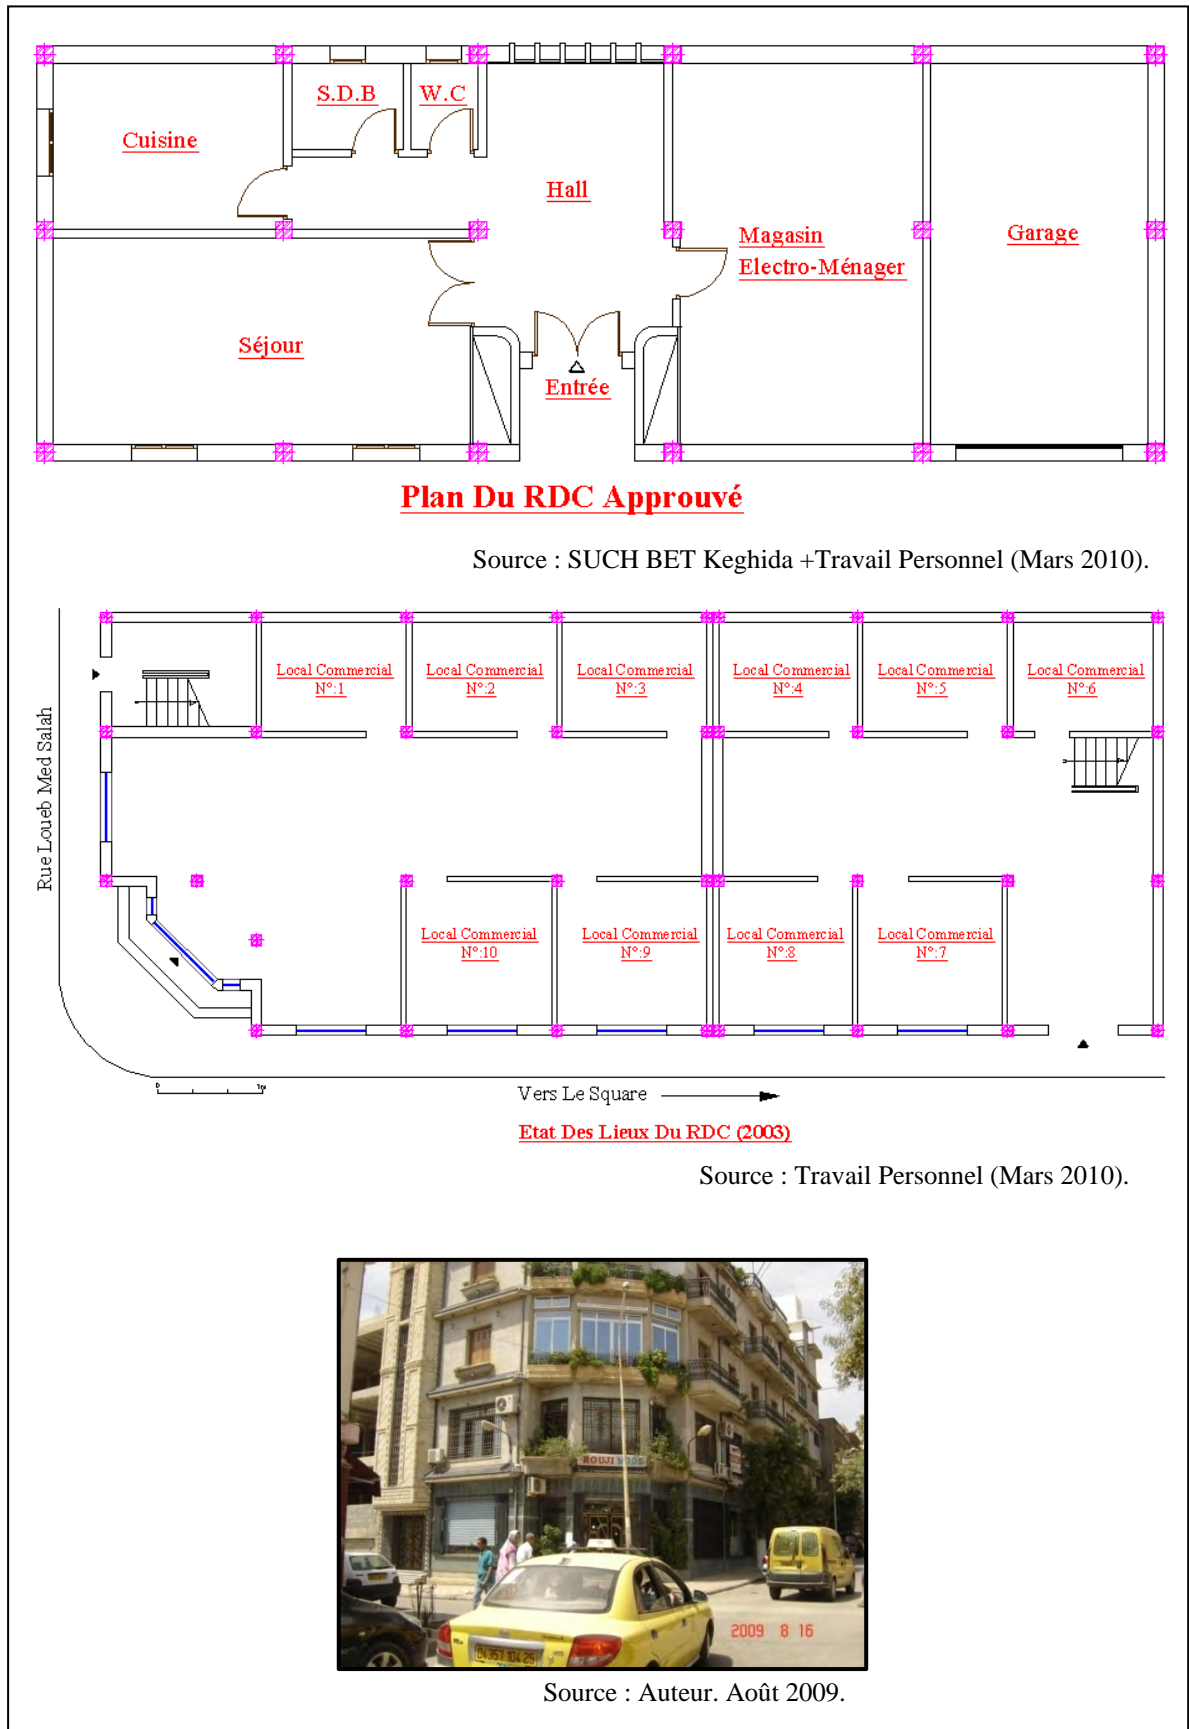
Deuxième exemple d'une maison; la non conformité des plans aux permis de construire.
